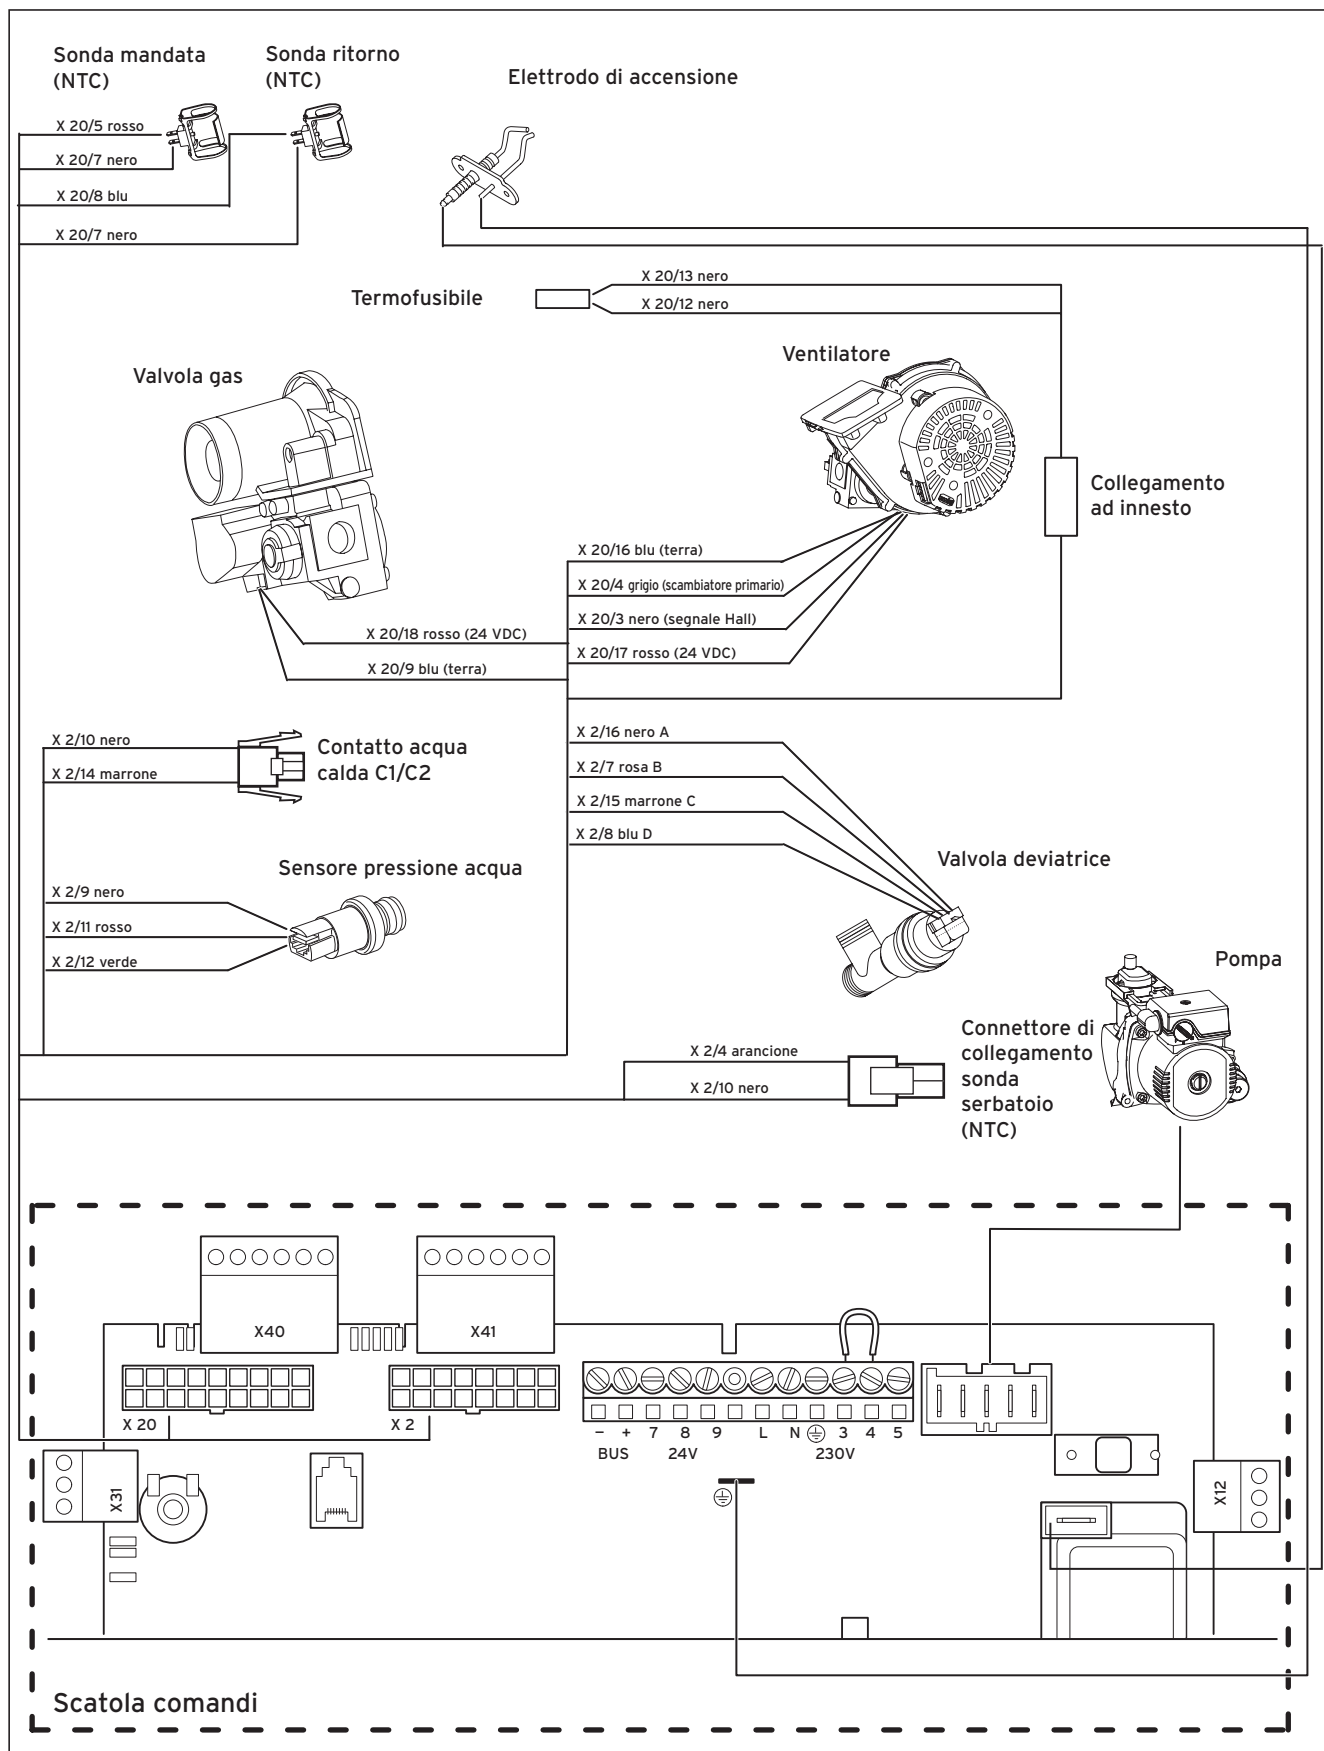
Schema di cablaggio ecoBLOCK VM
